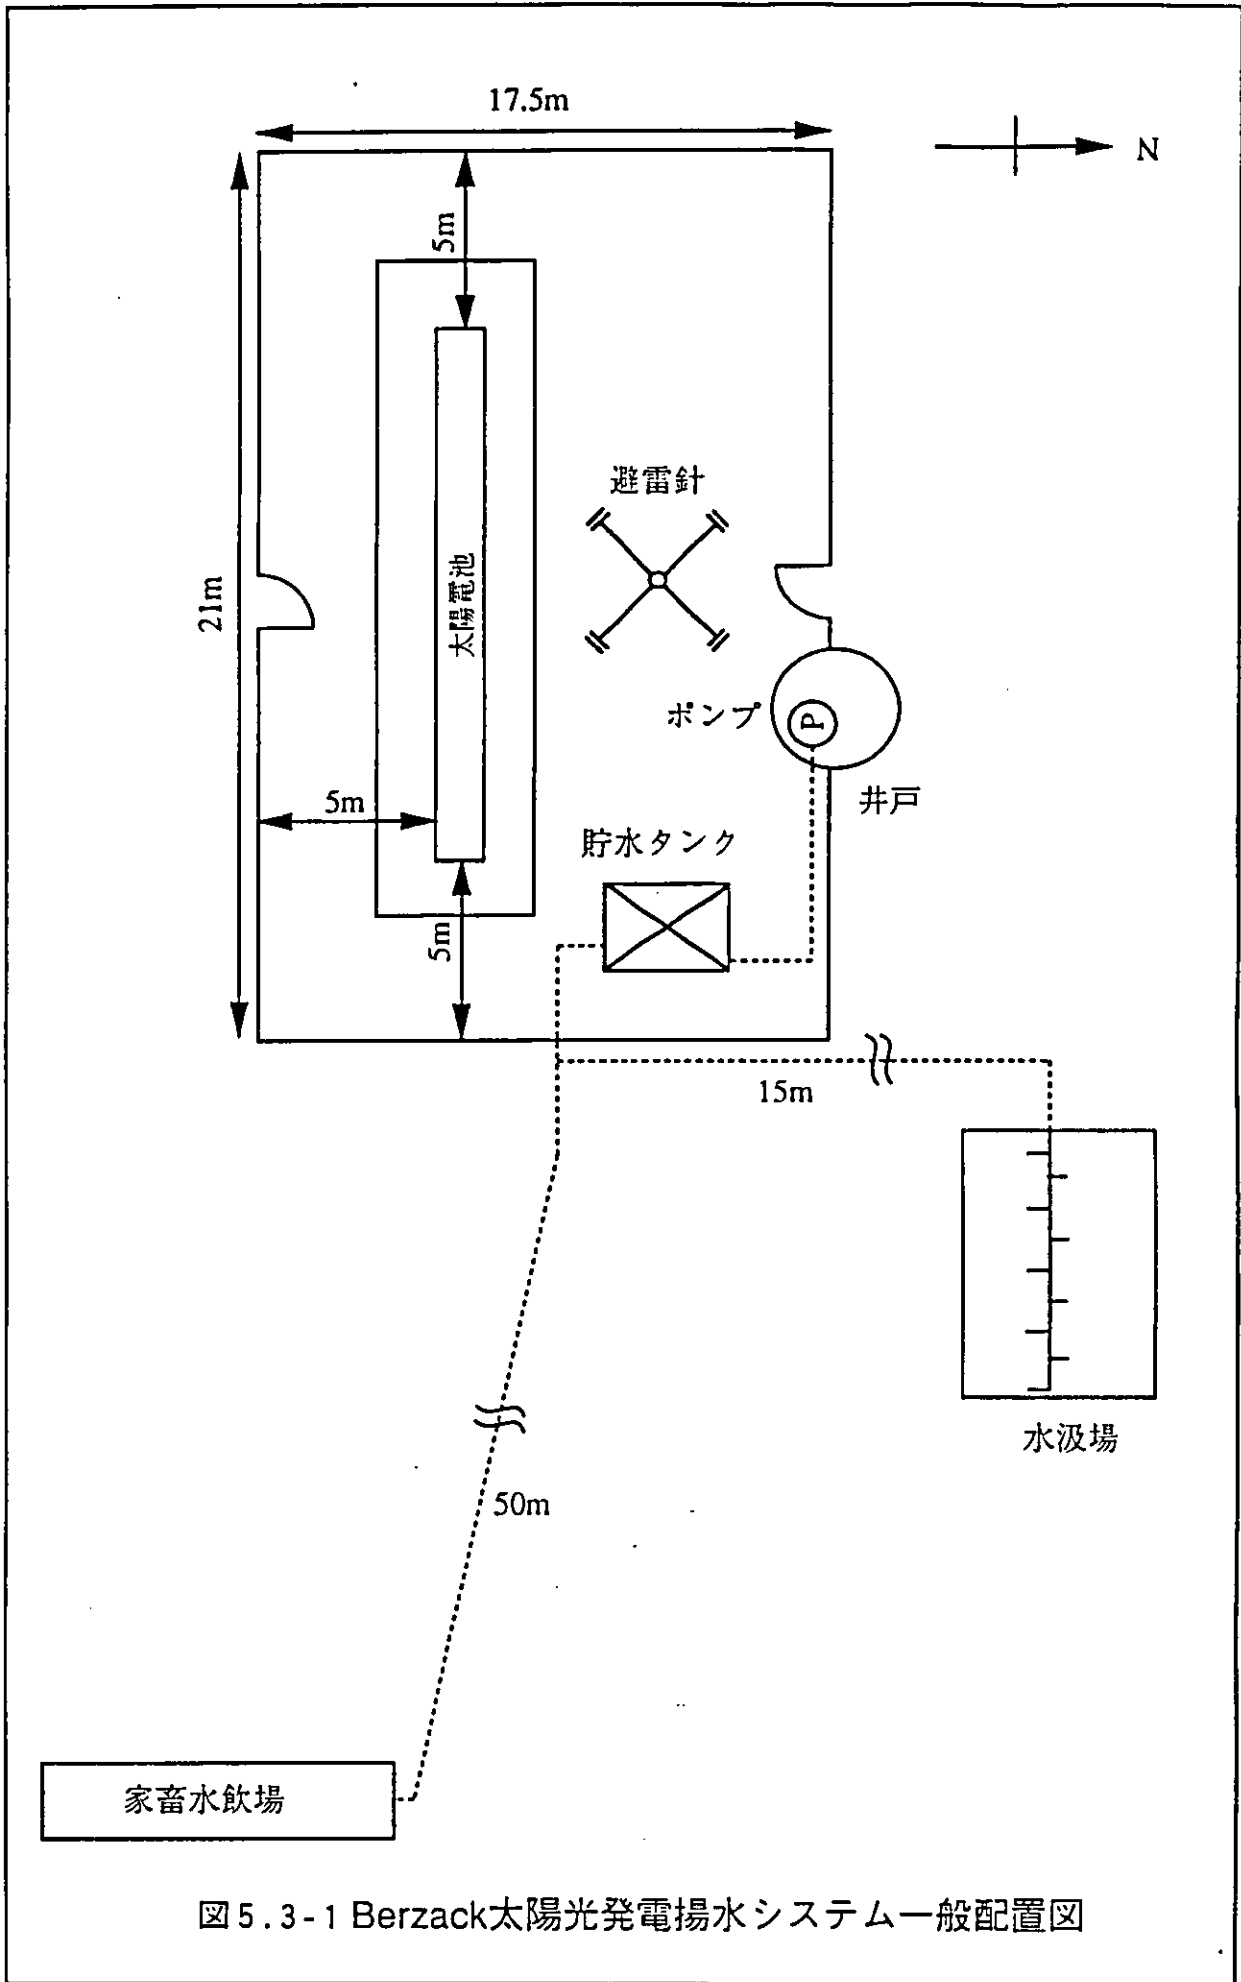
Berzack太陽光発電揚水システム一般配置図
